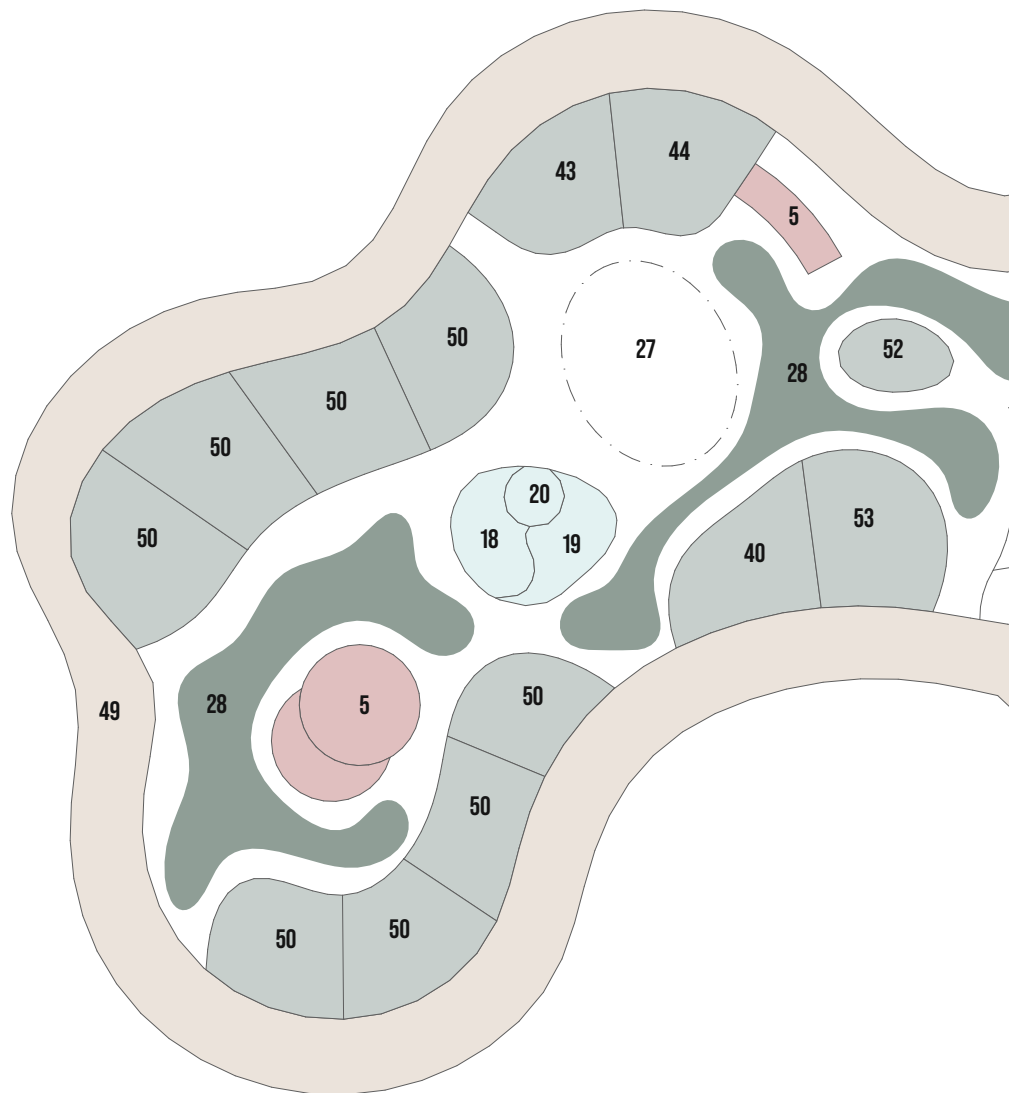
Raumprogramm, Grundriss, Erdgeschoß
